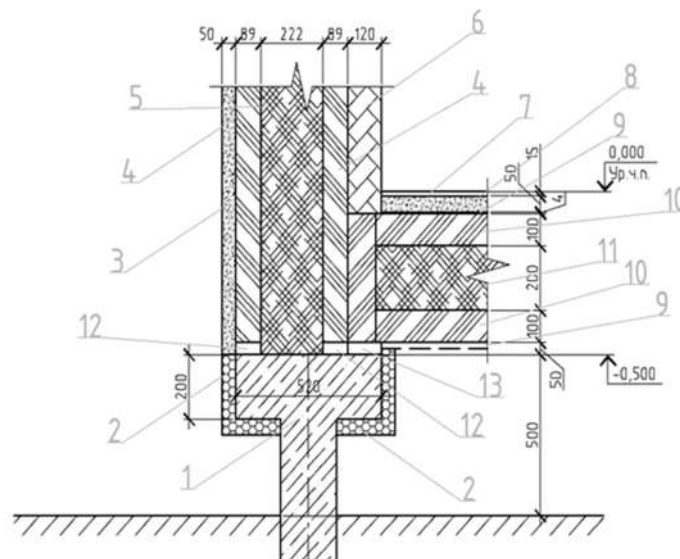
Опирання зовнішньої стіни і перекриття на вим.0,000 на конструкцію фундаменту (вузол 2): 1. з/б ростверк, 2.утеплювач (мінеральна вата), 3. глиняна штукатурка по дранці, 4.дерев'яні стійки; 5. утеплювач (пресована солома); 6. ґрунтоблоки; 7. керамічна плитка, 8. армований ґрунтобетон, 9. фанера; 10. дерев'яна ферма із бруса 50х100 мм, висотою 400 мм із кроком 600 мм; 11. утеплювач (пресована солома), 12, 13 – обв'язування
